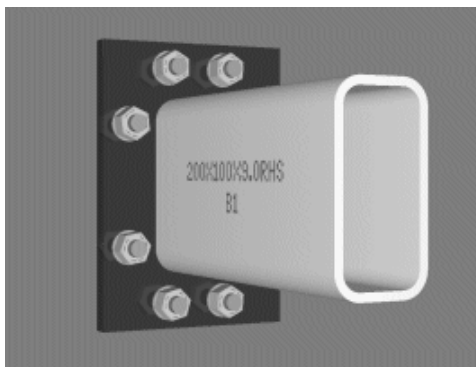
Exemplificação da extremidade de uma viga rectangular oca com placa de testa e ligação aparafusada STEEL-CONNECTIONS.COM (2011)
